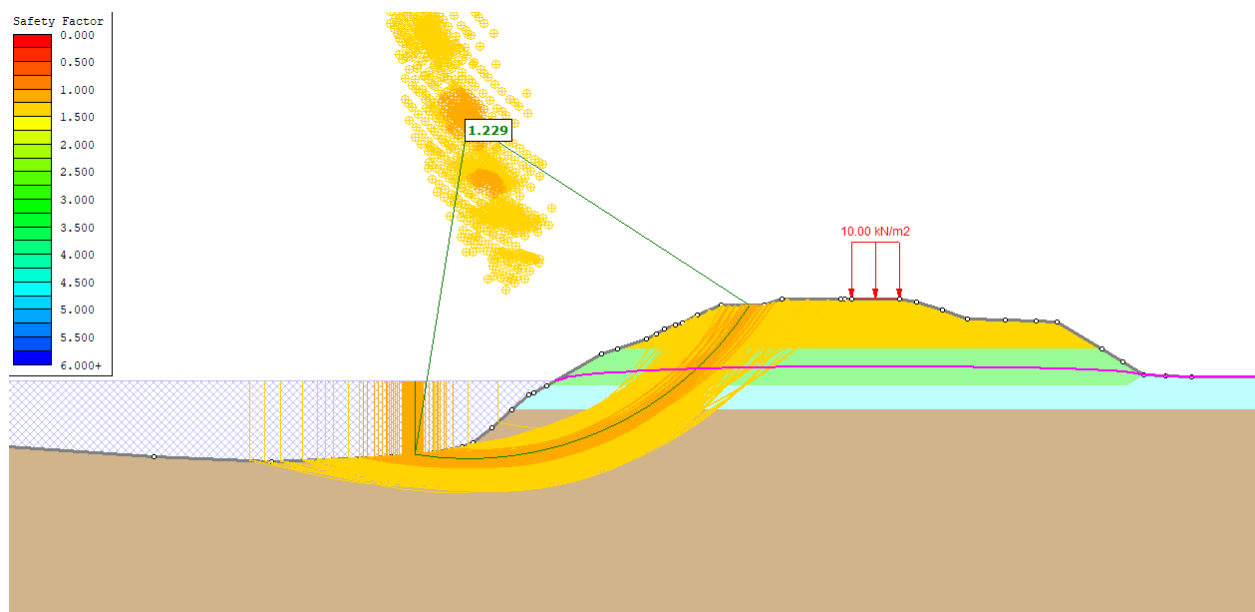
Sezione n.5 – Stato attuale – Analisi statica di svasso rapido dalla quota di piena SIMPO '82 – Parametri non drenati – Superfici di rottura con $FS < 1.4$
